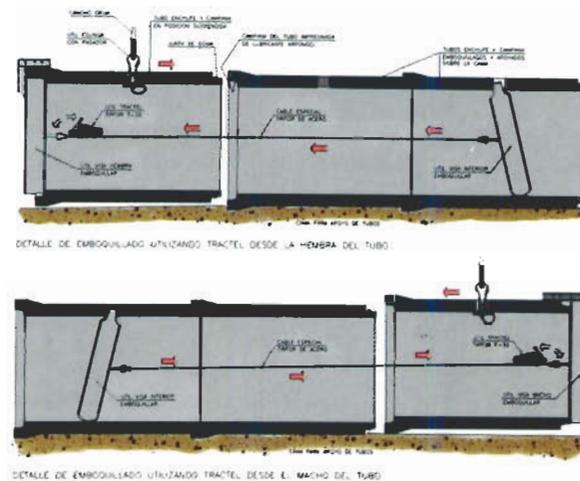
f Montaje de tubo con taladro de fábrica
